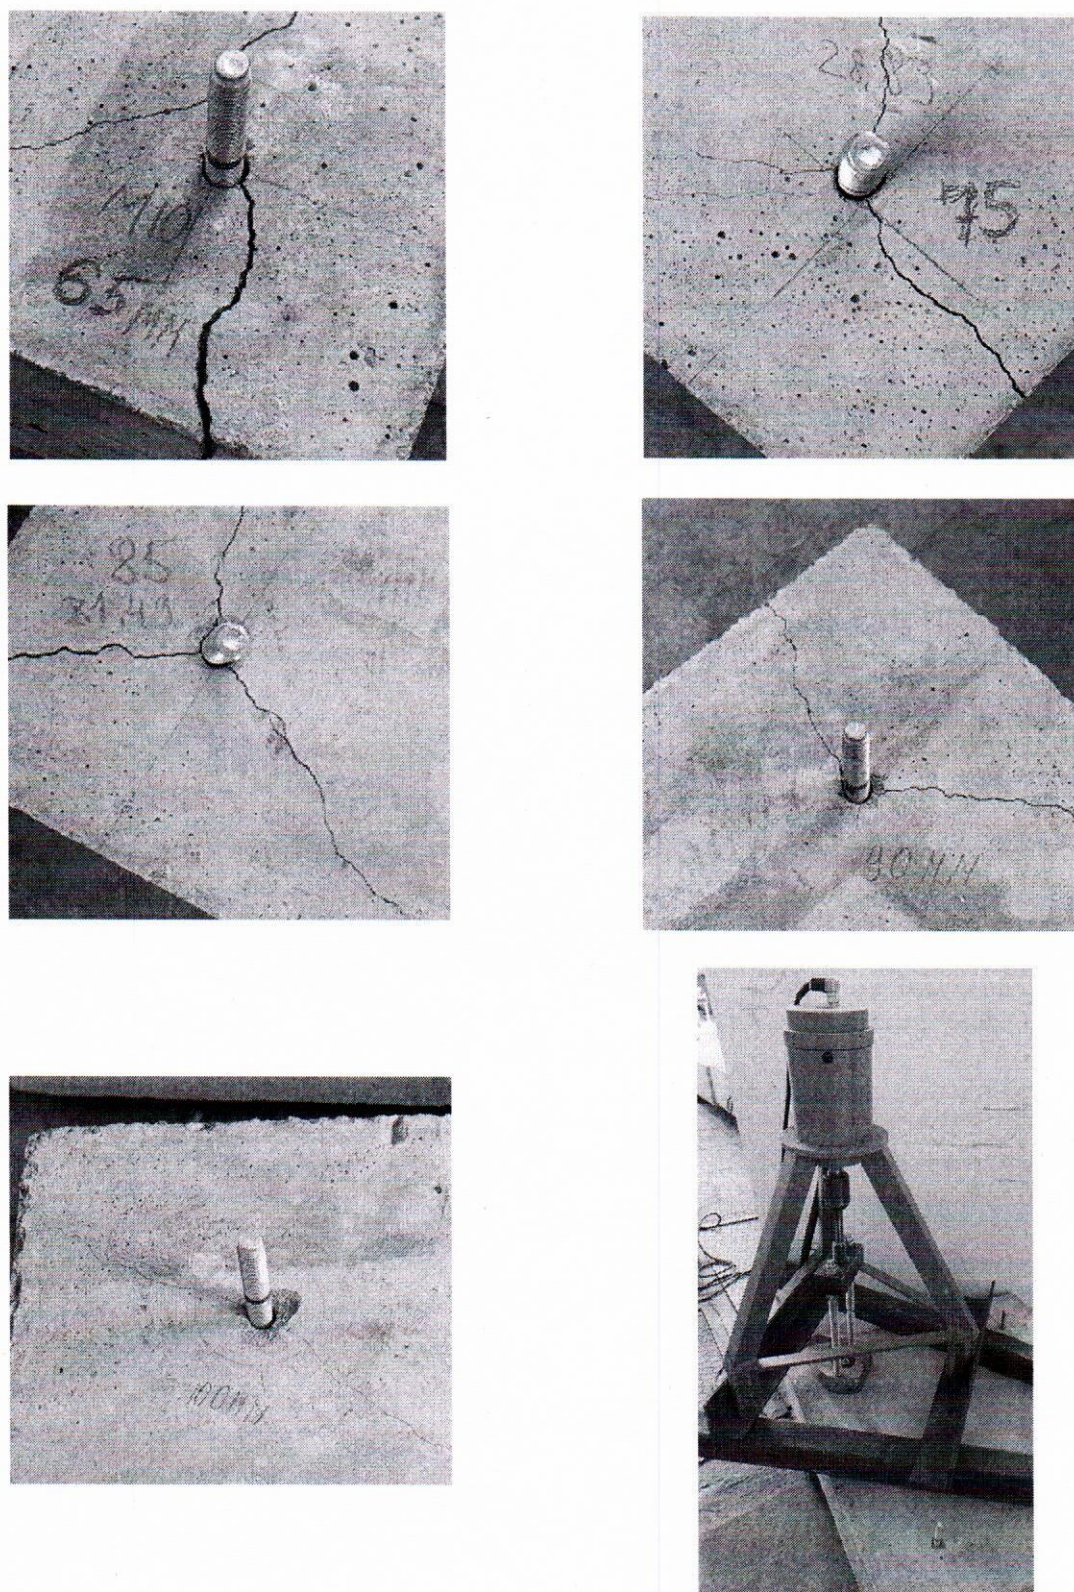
Серия F10. Разрушение бетона в углу плиты. Испытательная наладка.
